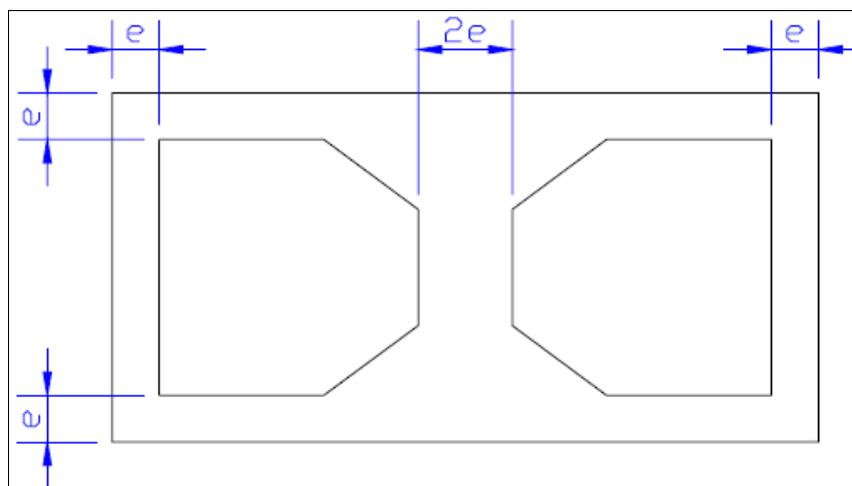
Espessuras mínimas das parede do bloco de concreto. Fonte: NBR5712:1982.
